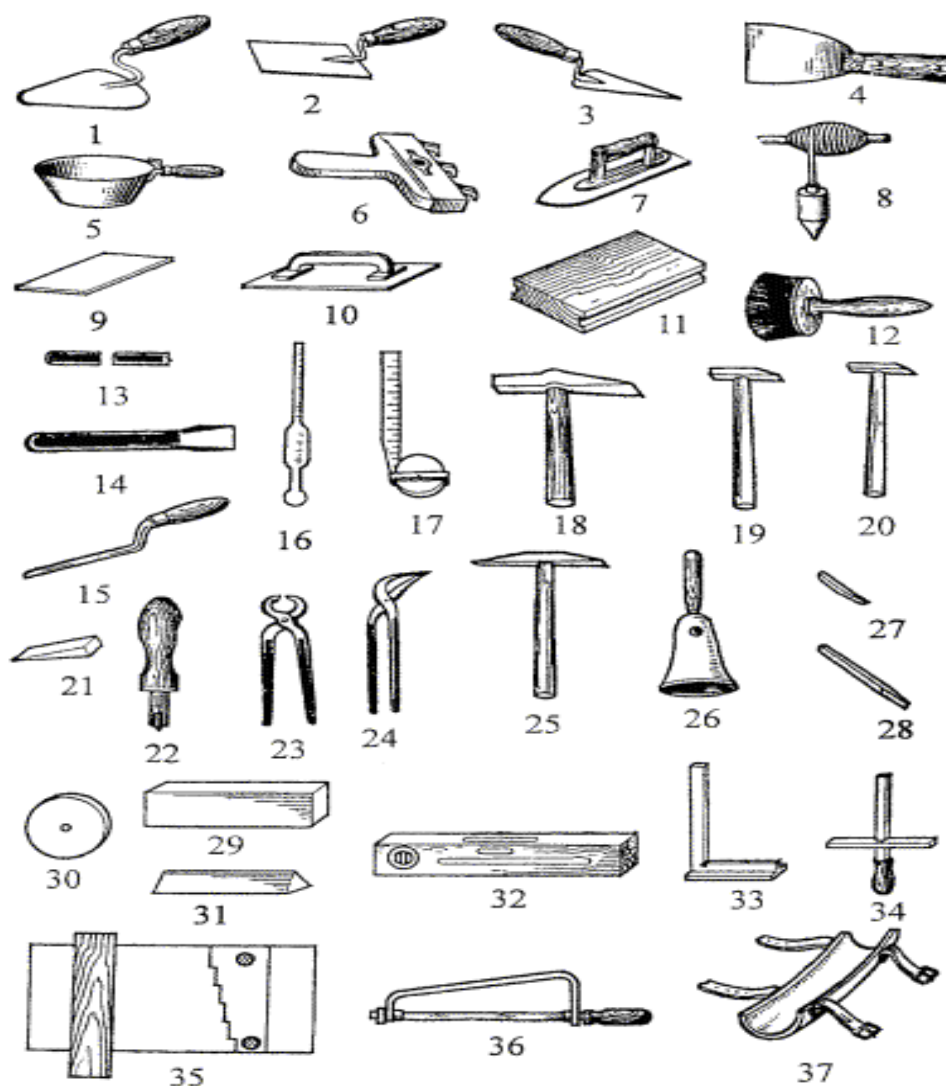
Ручний інструмент лицювальника-плиткаря:
